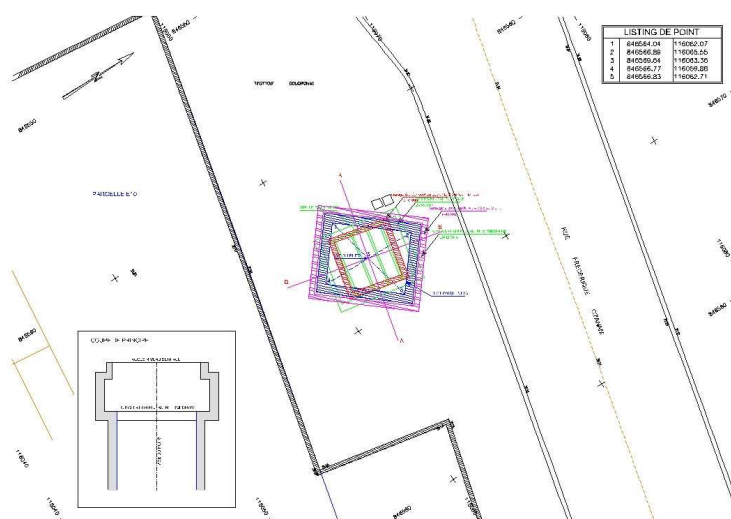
Vue en plan générale des ouvrages (existant et à réaliser)
